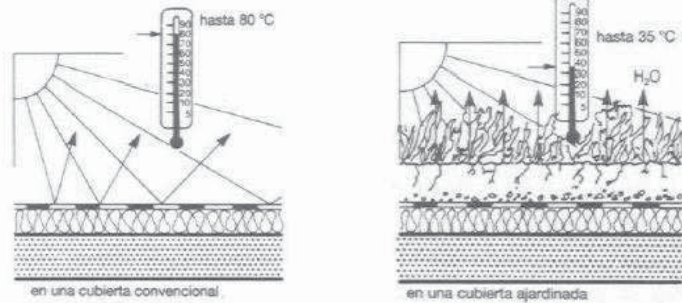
se utilizaran cubiertas y muros vegetales ya que traen beneficios importantes además de aportar áreas verdes al proyecto. Aislamiento térmico a través de la cámara de aire existente entre el césped y la capa de tierra.
